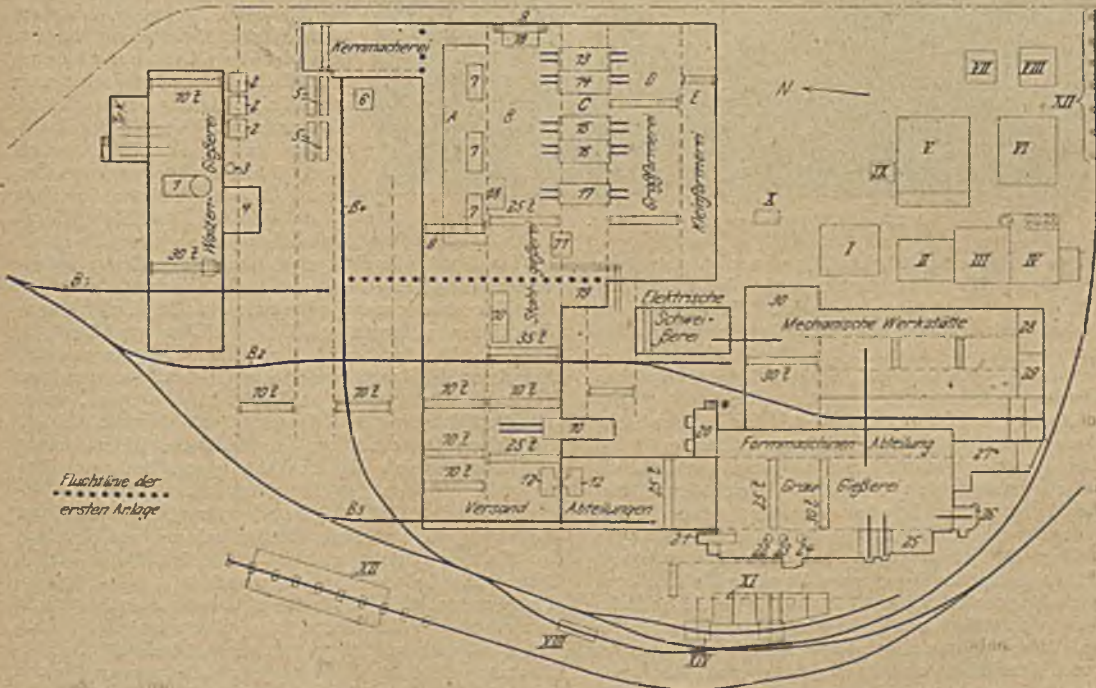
Lageplan der Birdsboro Steel-Foundry and Machine Comp.
